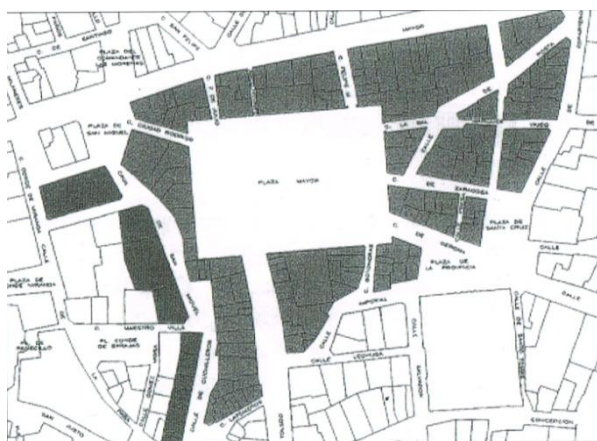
Plano general de la intervención en la Plaza Mayor
